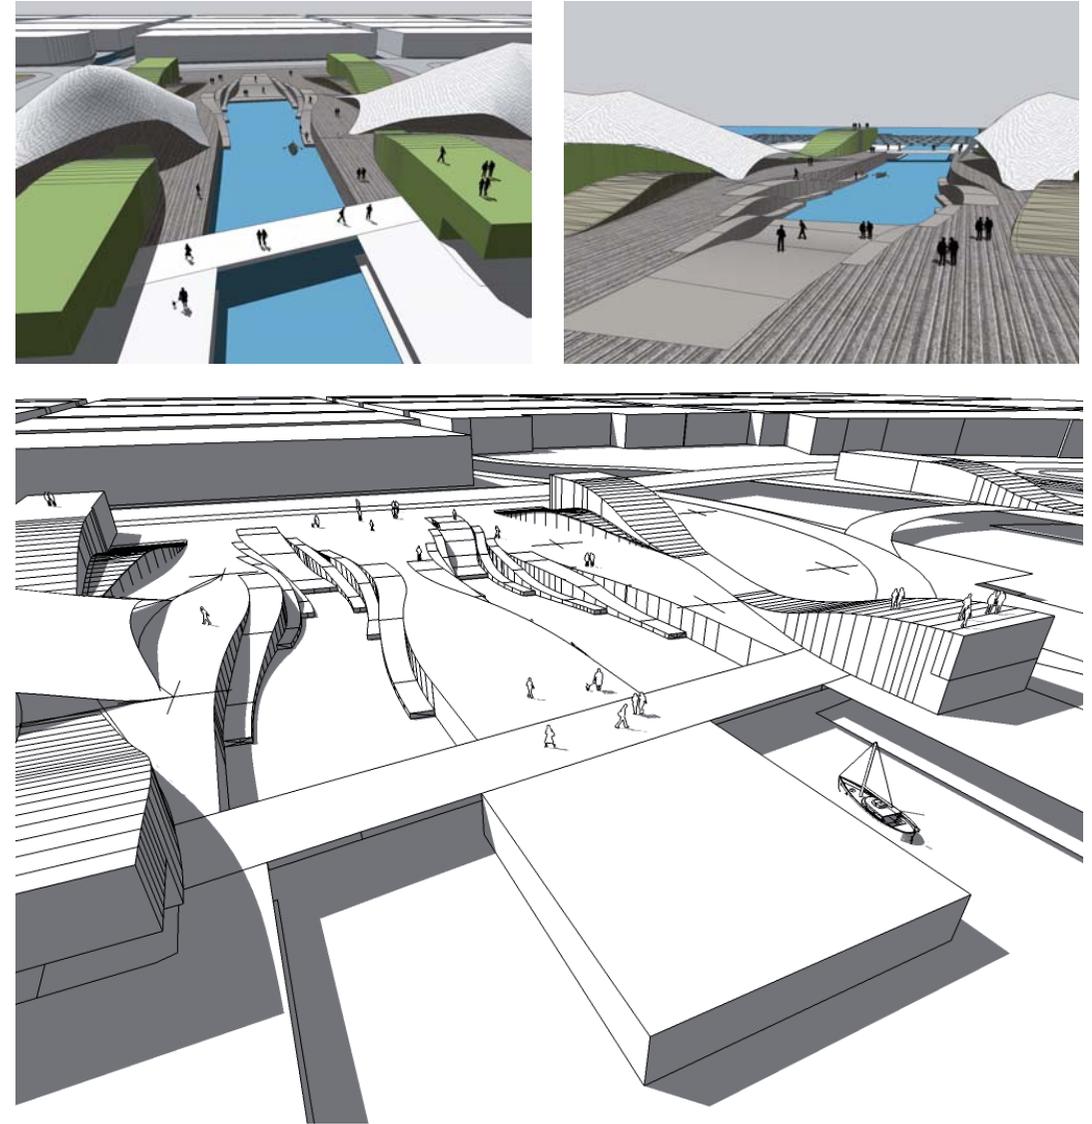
JC. Olivas. Planimetría y volumetría del área desarrollada.2012.
